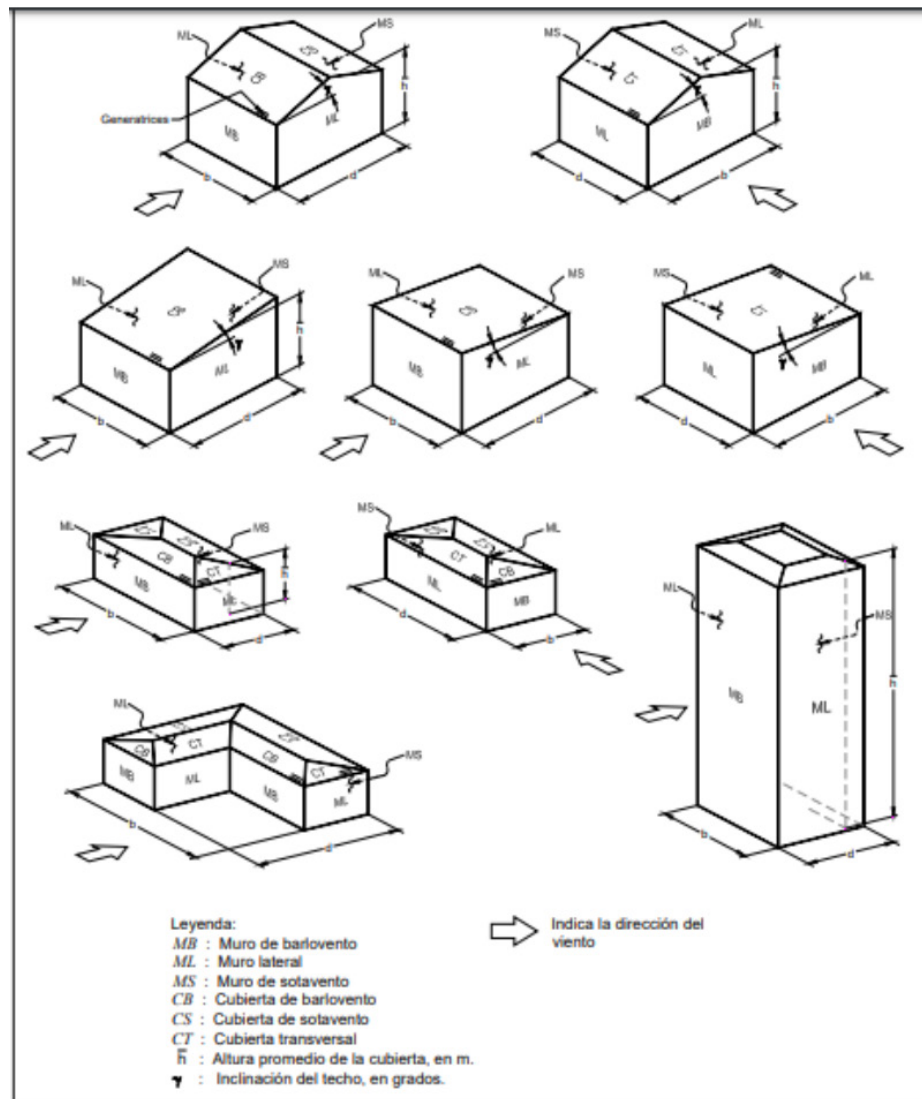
Definición de parámetros de construcciones con planta cerrada.
